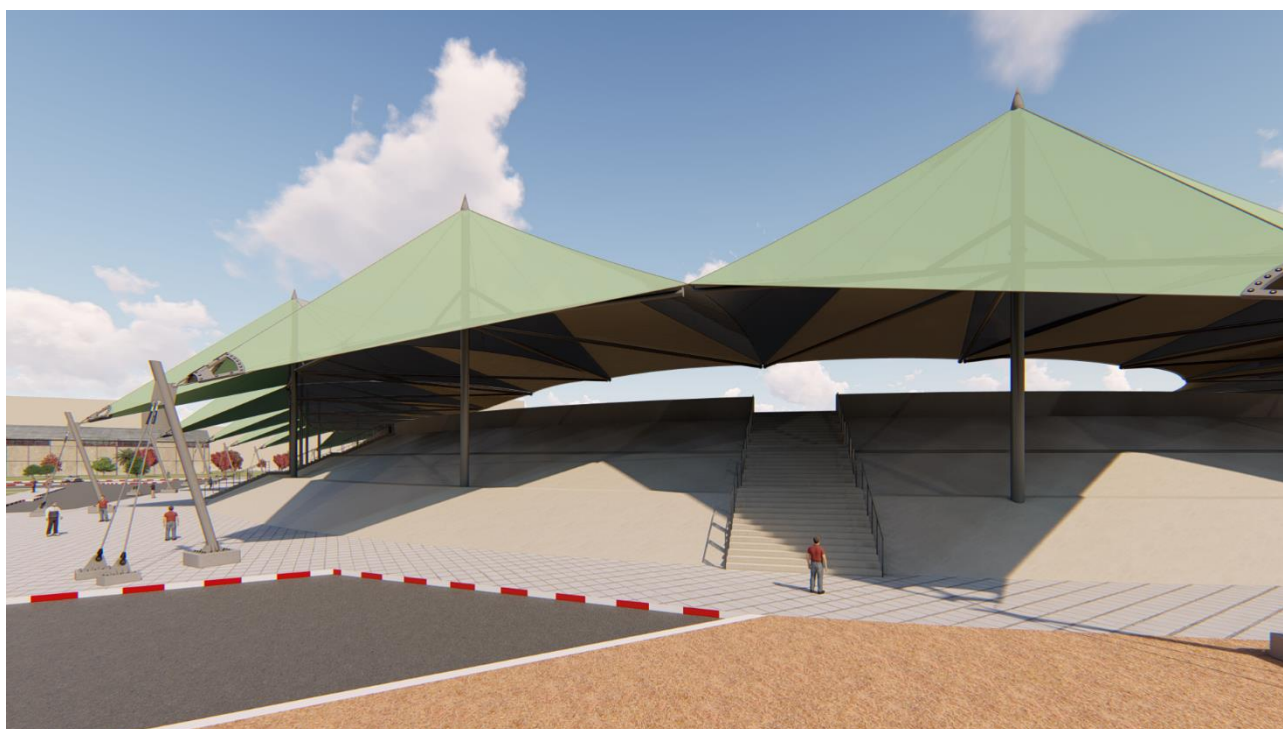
Vue sur une entrée vers les tribunes .façade sud-ouest
